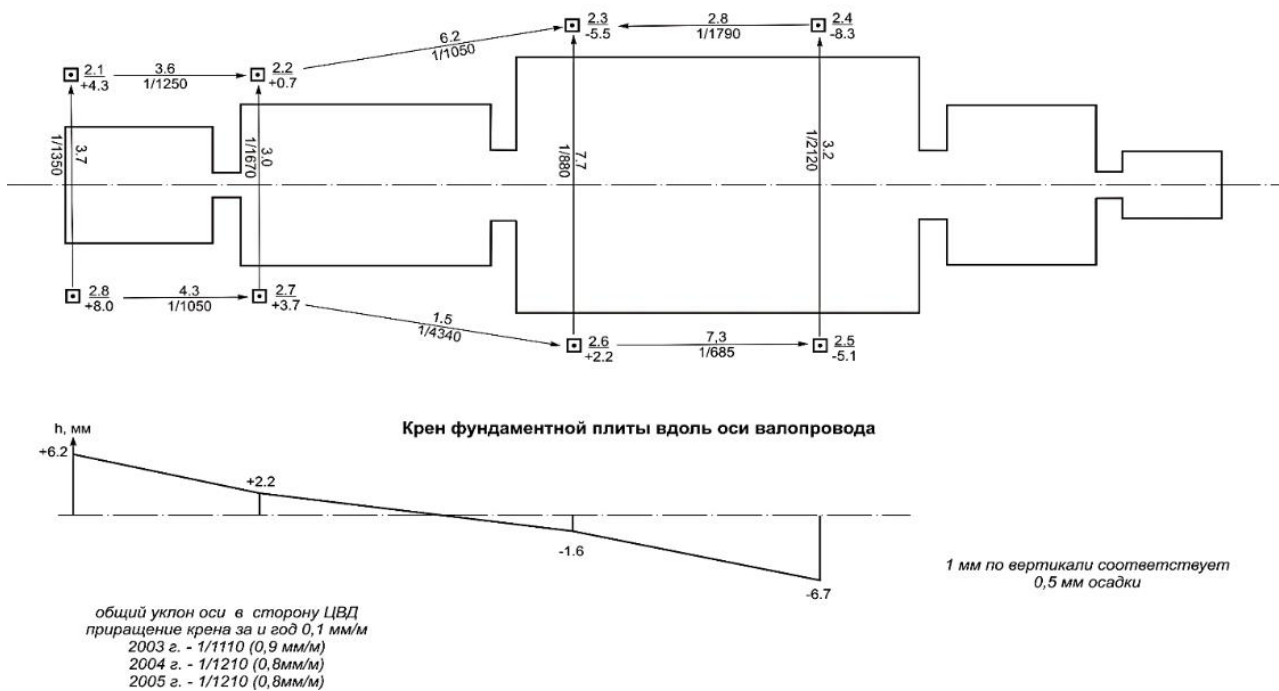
Схема продольных и поперечных кренов верхней фундаментной плиты турбоагрегата
